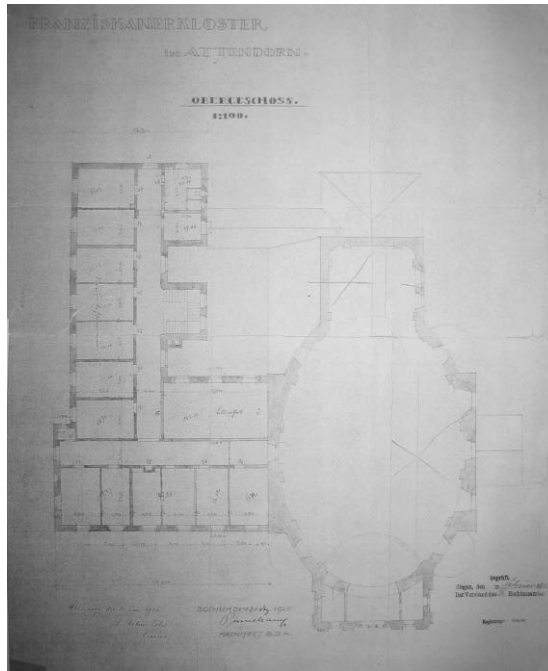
Grundriss Obergeschoss, 31.12.1925
